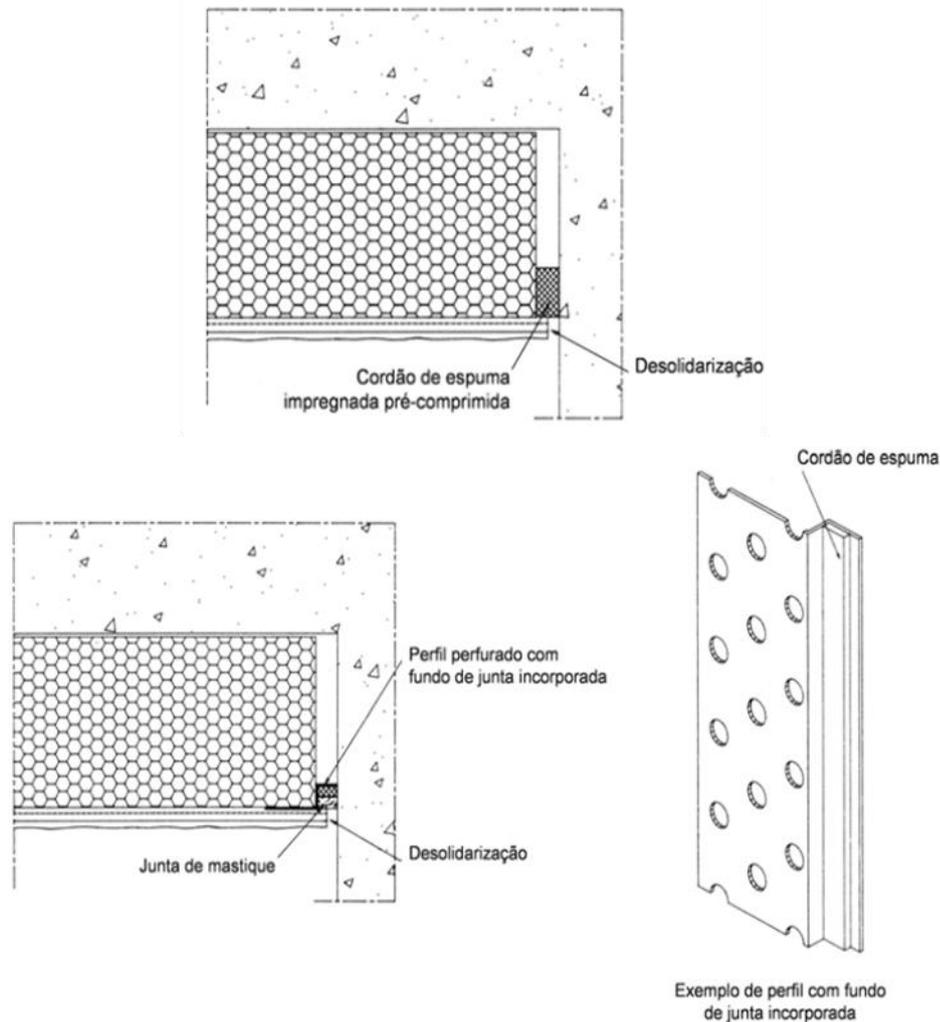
Pormenores de ligações do sistema com elementos construtivos (corte horizontal) [4]
